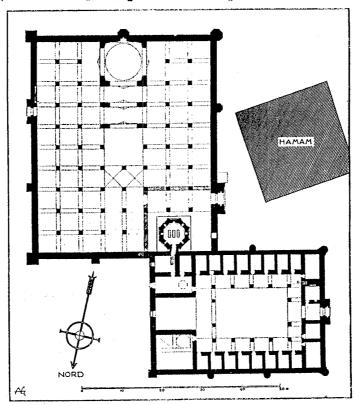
مسقط أفقي لمدرسة انجه مناره لي في قونية (الوزير صاحب عطا) ١٩٥٨هـ/١٢٦١م : مسقط أفقي .
